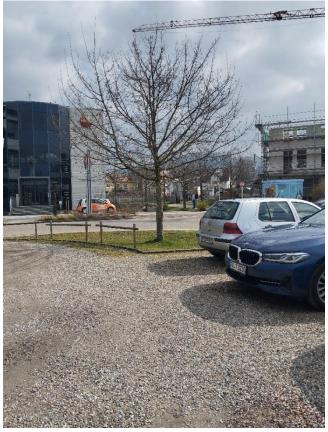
Bestehendes Feuerwehrgebäude mit Sicht auf die Anschlusstelle für den Anbau
